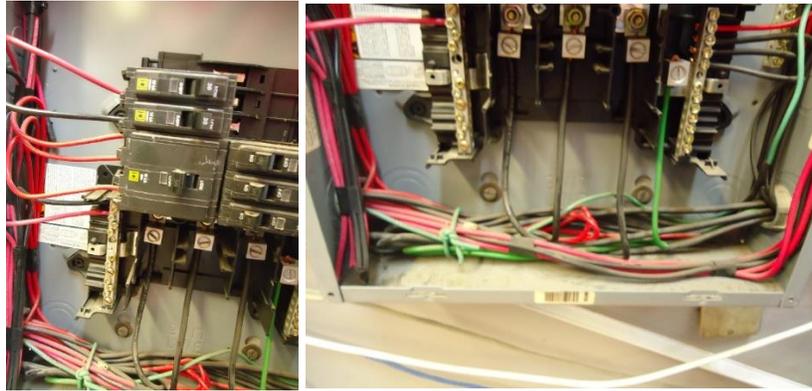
Pastillas, zapatas y cables del tablero P1B.
